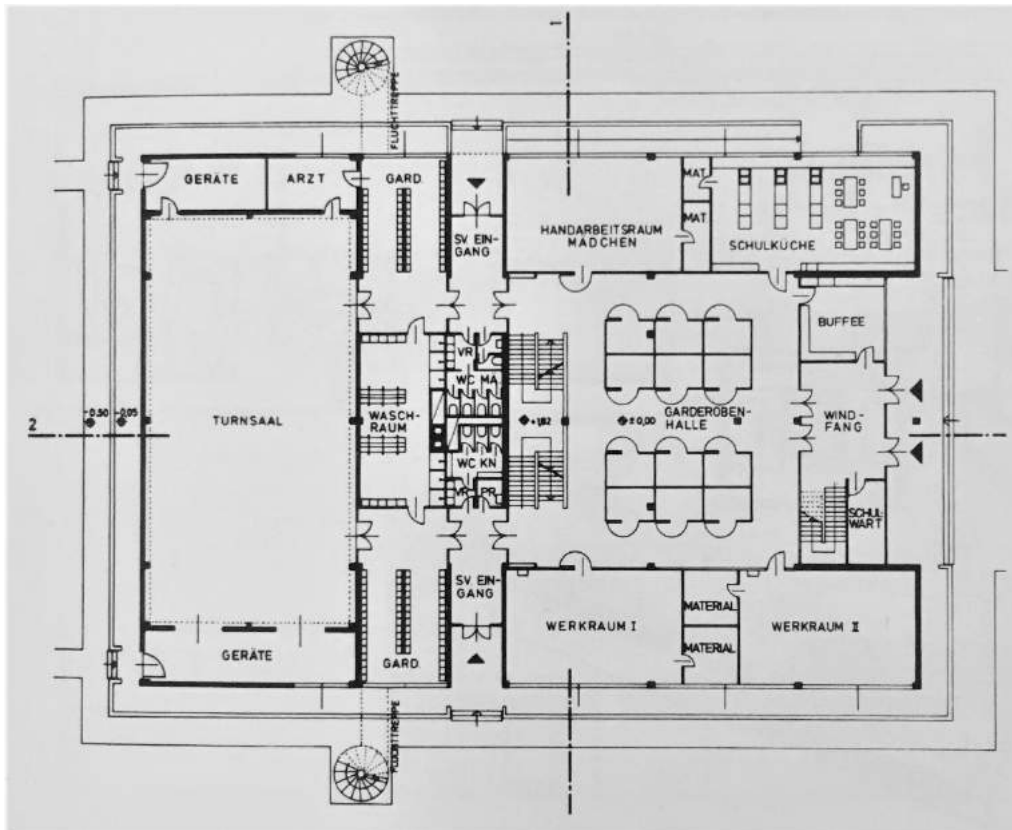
Hauptschule Mauer Öhling, Grundriss Erdgeschoss, 1976
